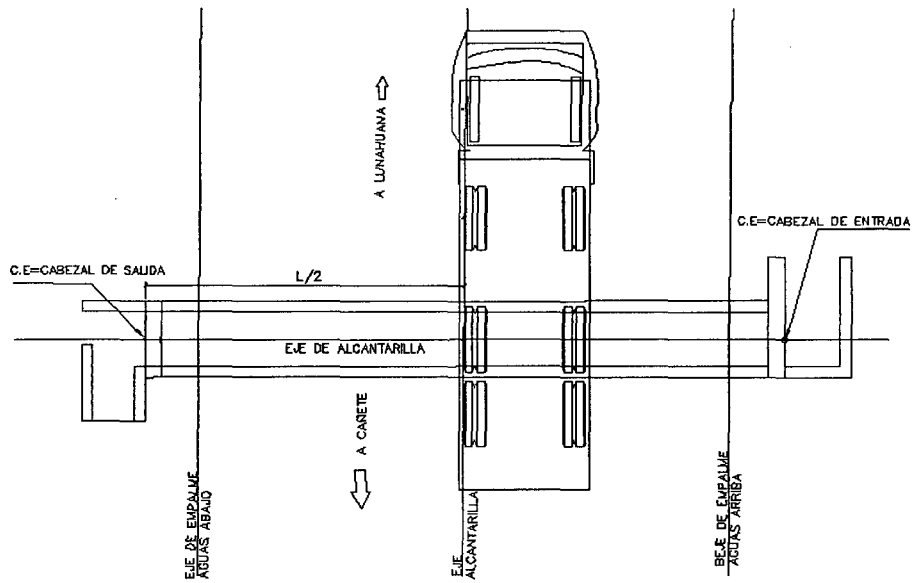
Ubicación del camión en planta para la prueba de junta con carga en el centro de alcantarilla
